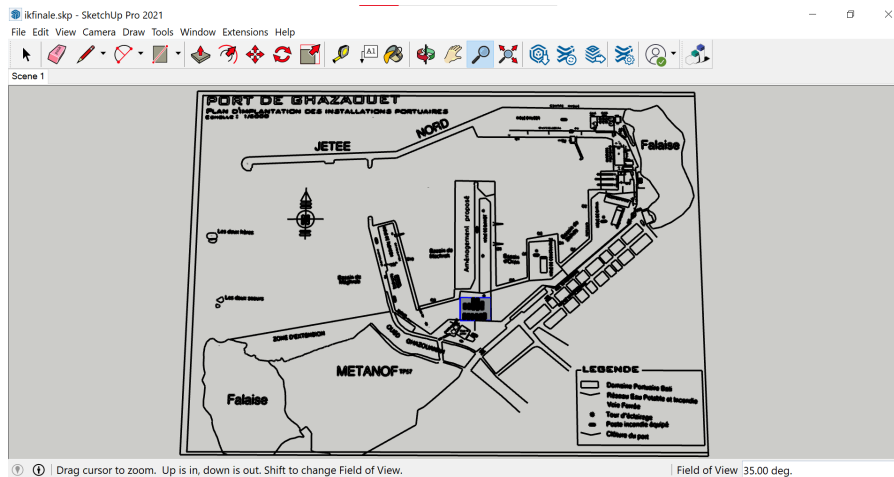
Plan de port de ghazaouet sur sketchup.
